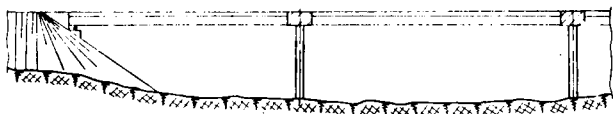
Схема моста (штриховкой показан бетон омоноличивания)
